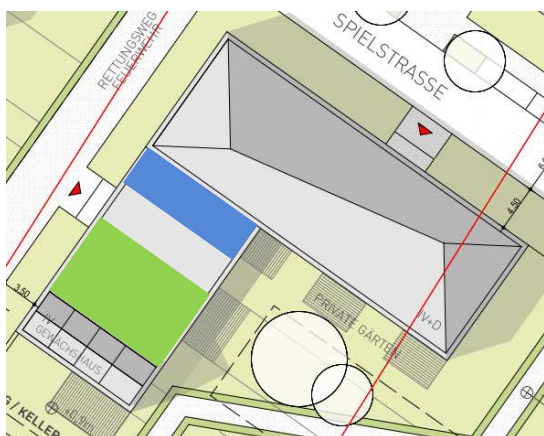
Ausschnitt Lageplan vom 06.04.2022, Gebäude mit Dachterrasse und Gründach
